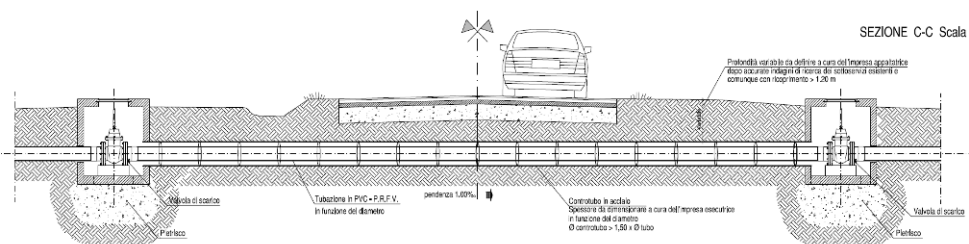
Sezione tipo delle soluzioni di sottopasso stradale. – Allegato B.7.6.
